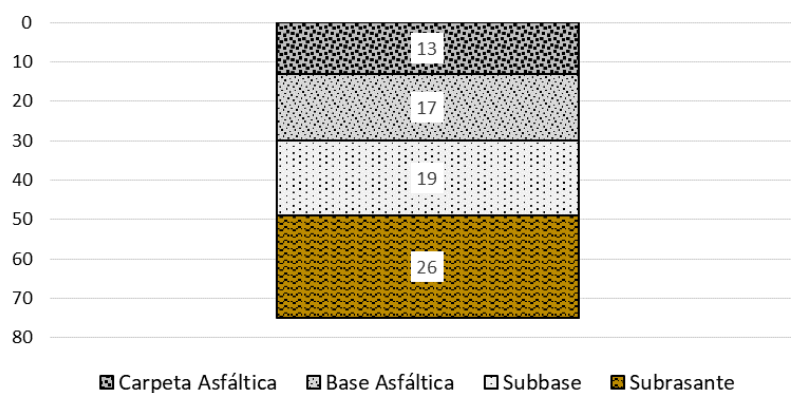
Estructura de Pavimento Flexible Propuesta
